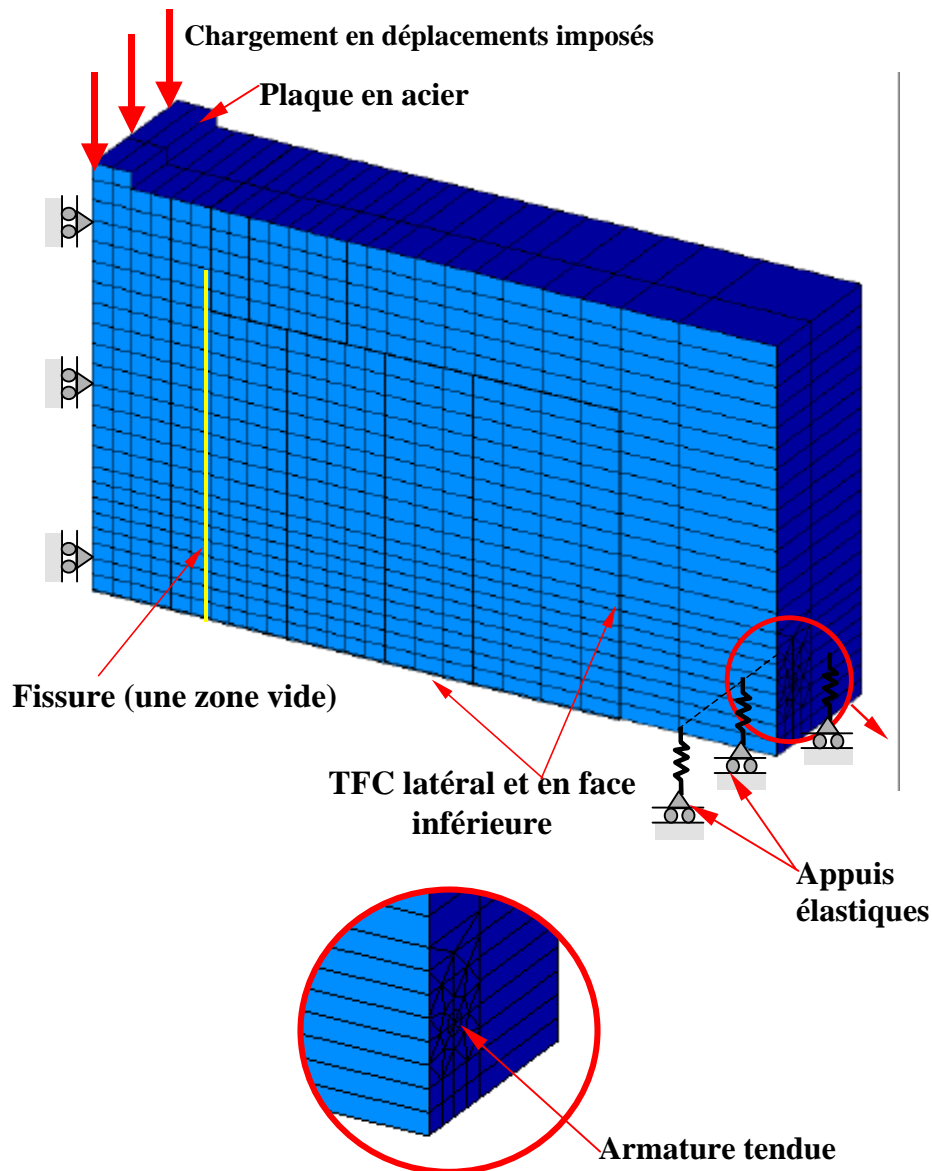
Maillage en 3D des poutres courtes pré-fissurées et renforcées en face tendue et latéralement (11775 nœuds et 2664 éléments)
